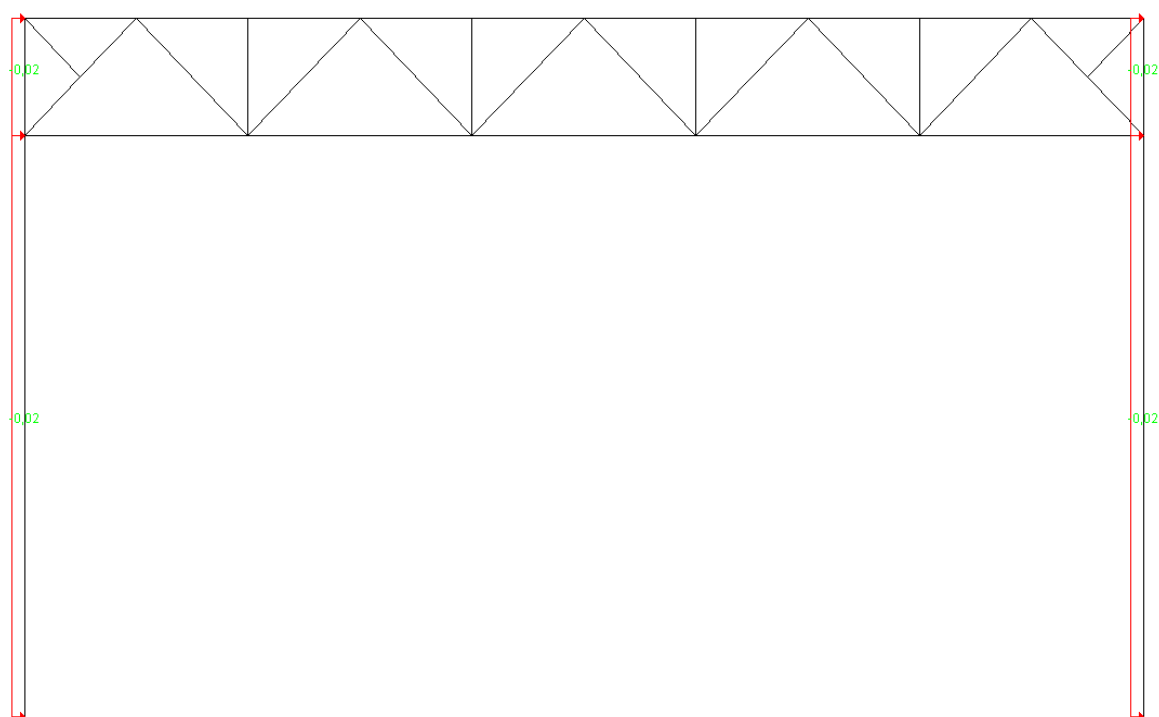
Схема приложения ветровой нагрузки на раму
